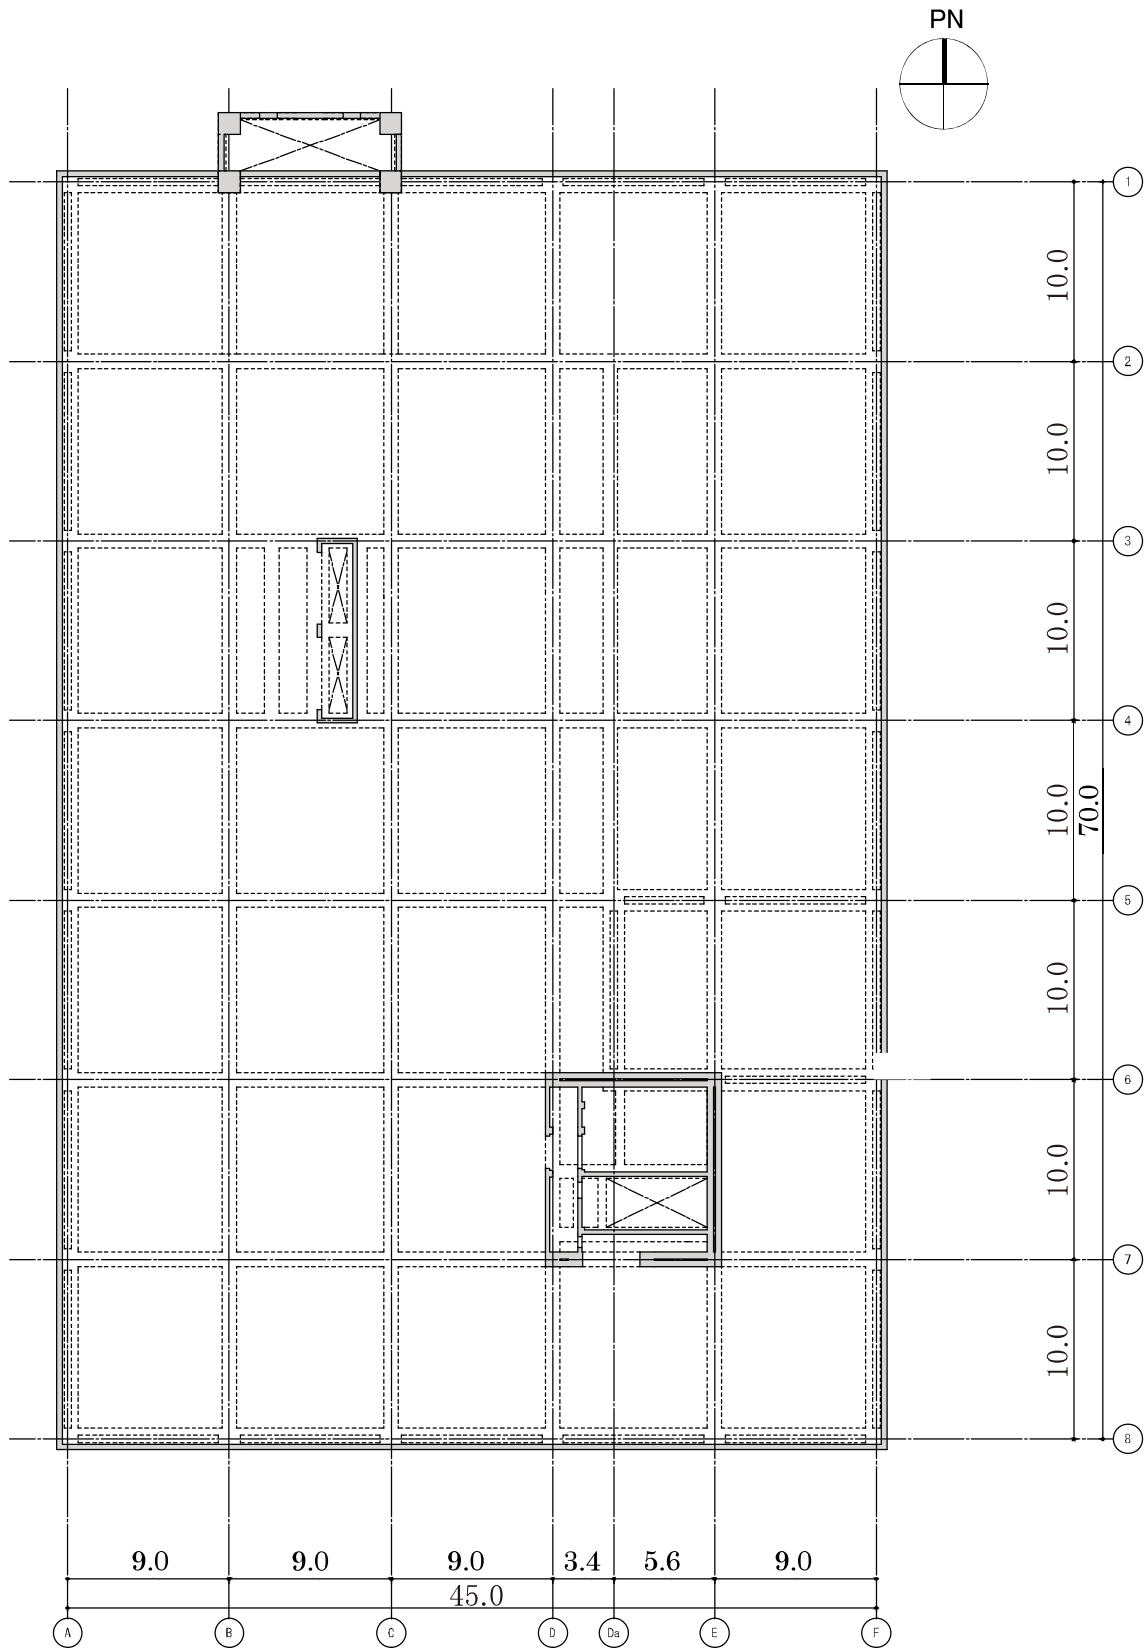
屋上階平面図 (G. L. +24. 30) (单位 : m)
